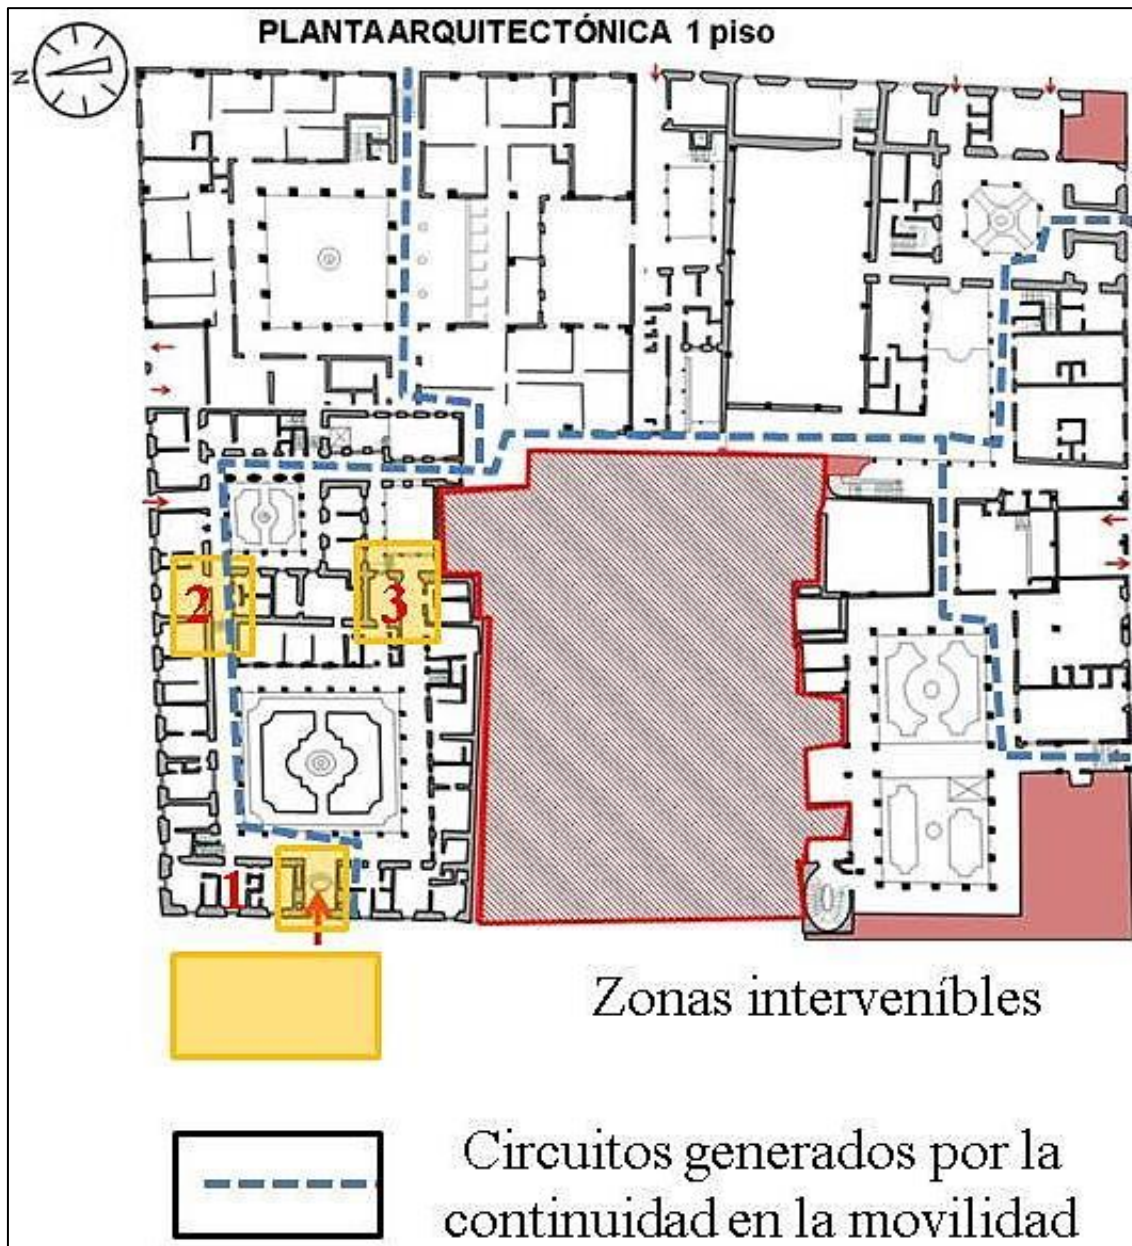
Propuesta de zonas para adaptación de rampas y salvaescaleras (Fuente: elaboración propia, 2018)
